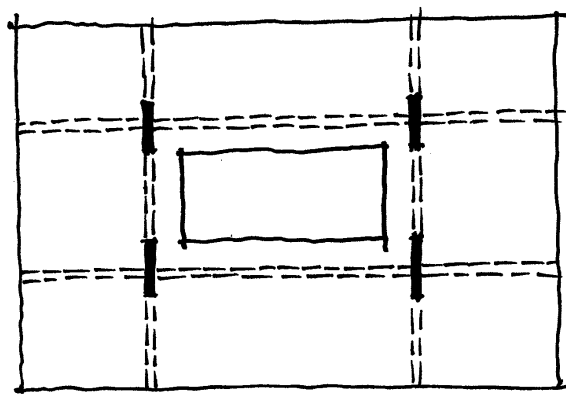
Planta de uma das lajes, mostrando os pilares, o cruzamento de vigas no coroamento e o vazio central. Fonte: desenho do autor
